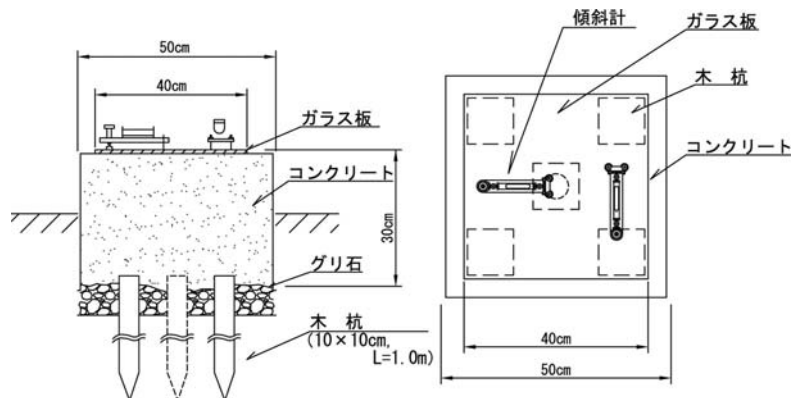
地盤傾斜計コンクリート基礎台設置図
